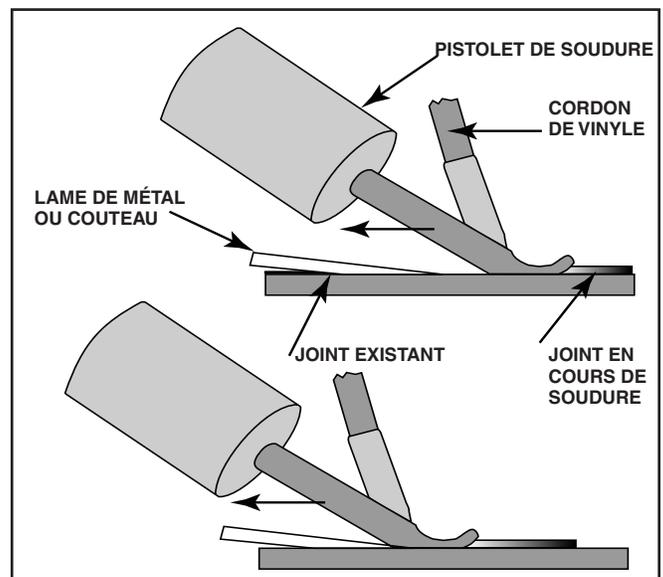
Terminer la soudure sur la lame de métal
